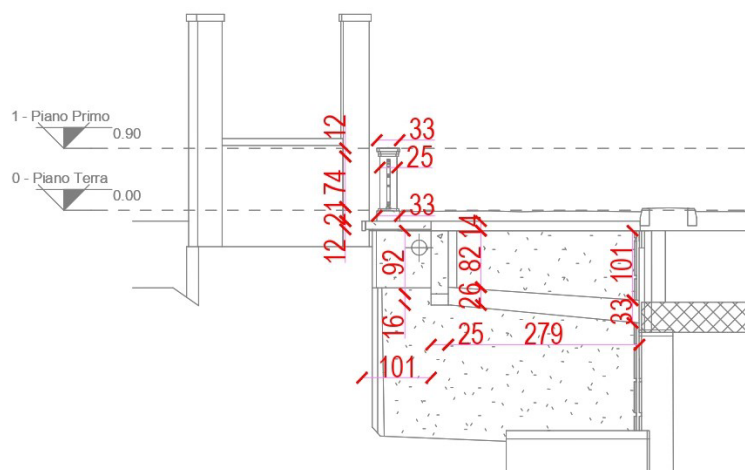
Sezione mensola sud-ovest - Stato di fatto
